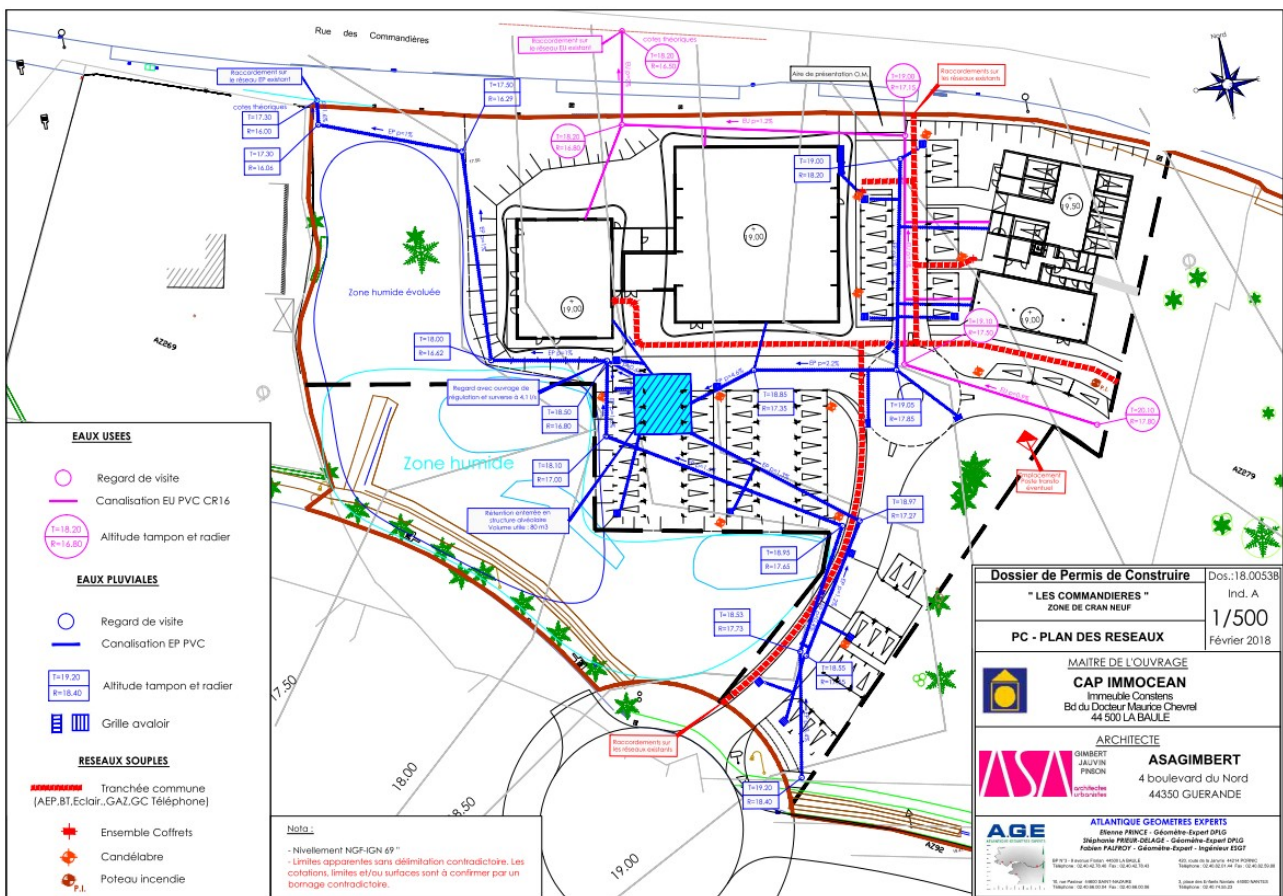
Gestion des eaux pluviales du lot 1 (Source : AGE)
